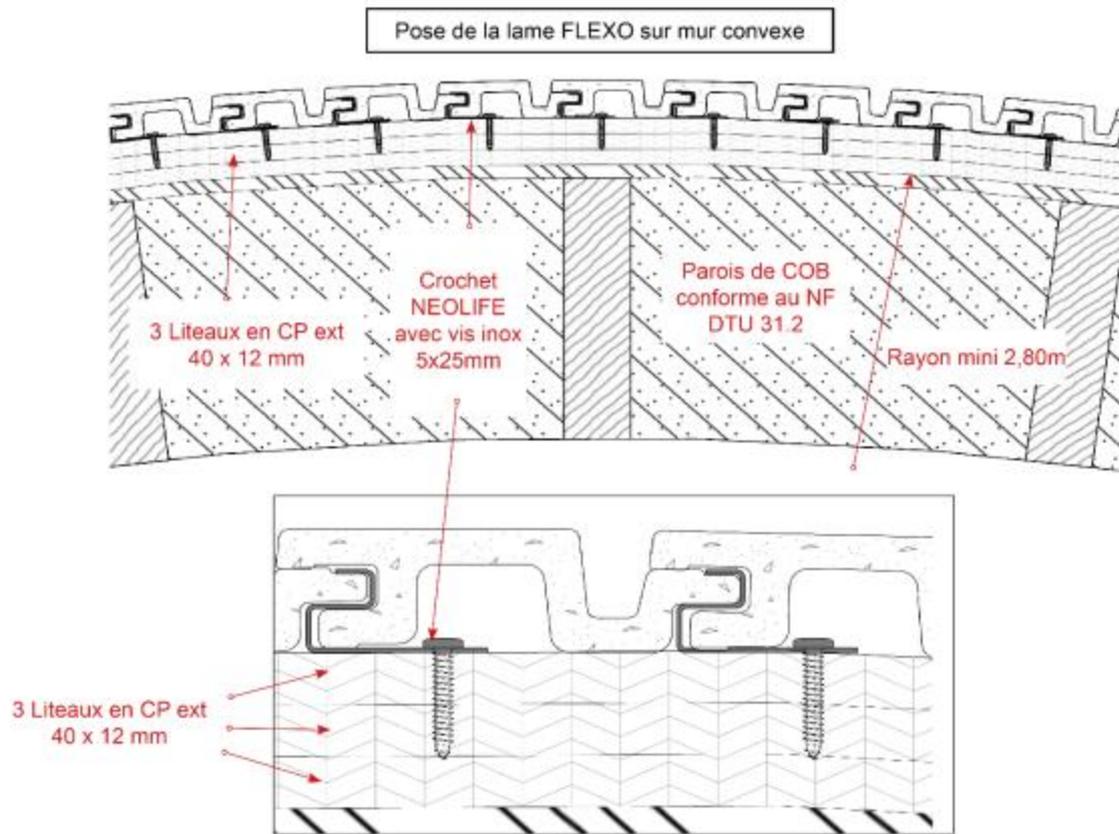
Principe de pose du profil FLEXO sur mur convexe
